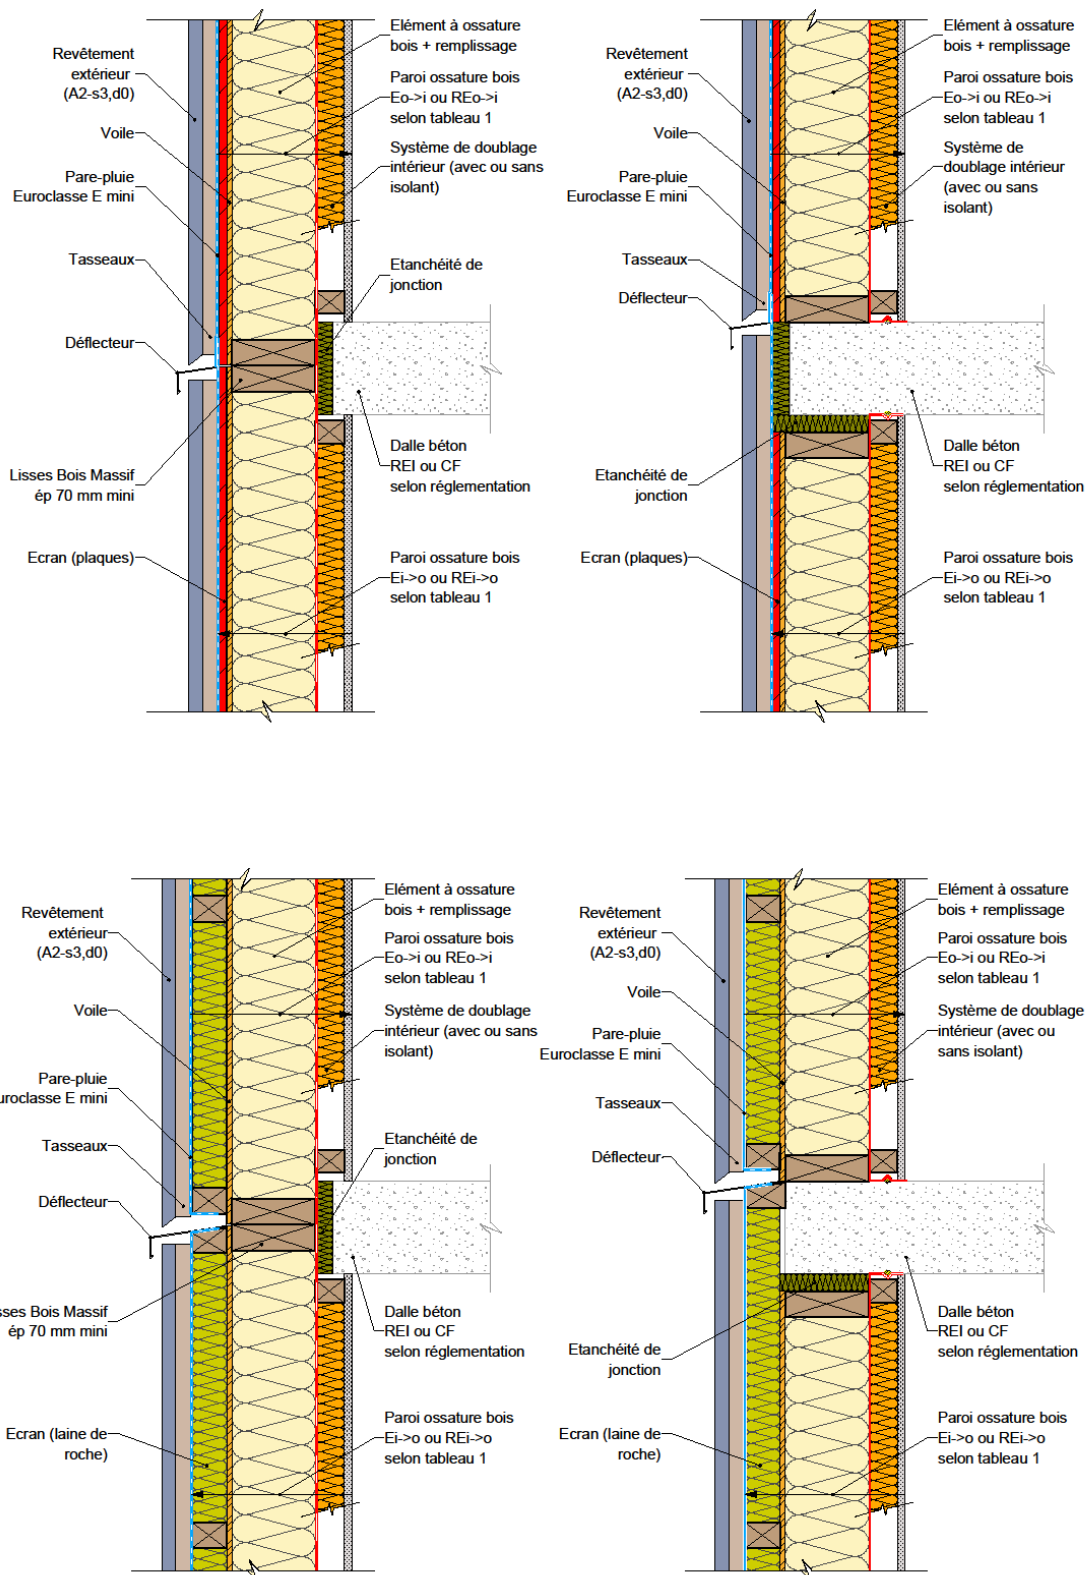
Façade/mur en ossature bois & plancher en béton.
